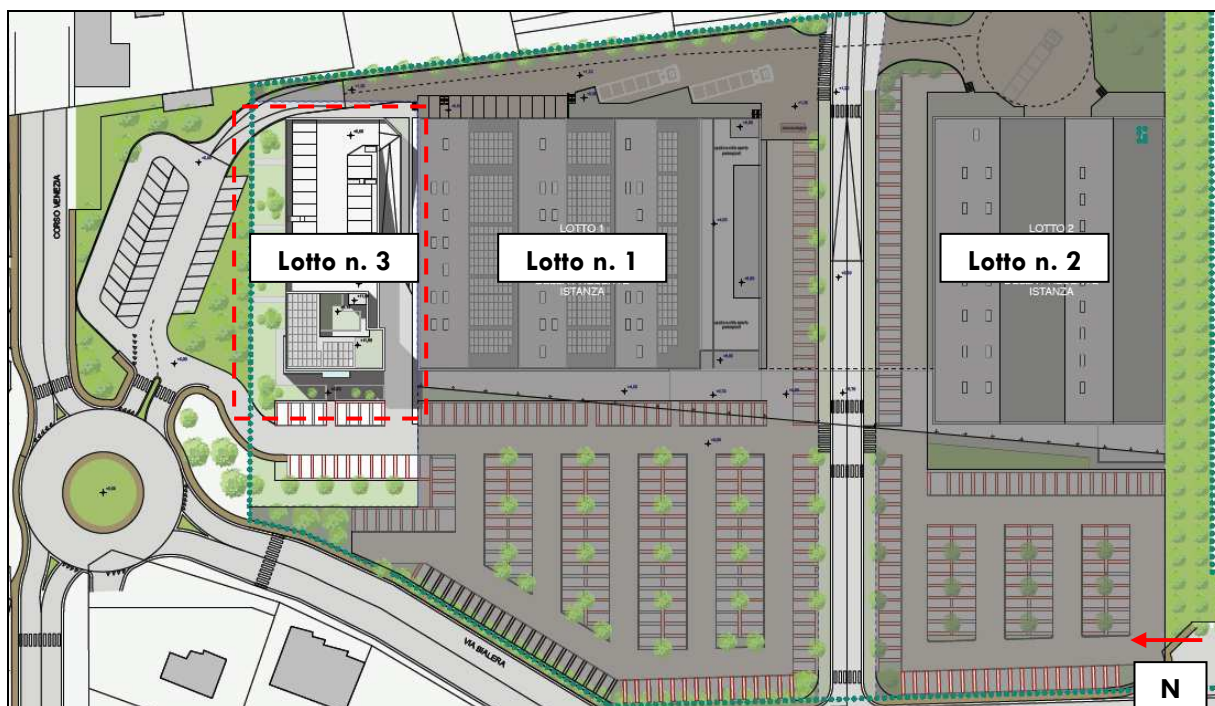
Estratto progetto architettonico: planimetria dei lotti di intervento
